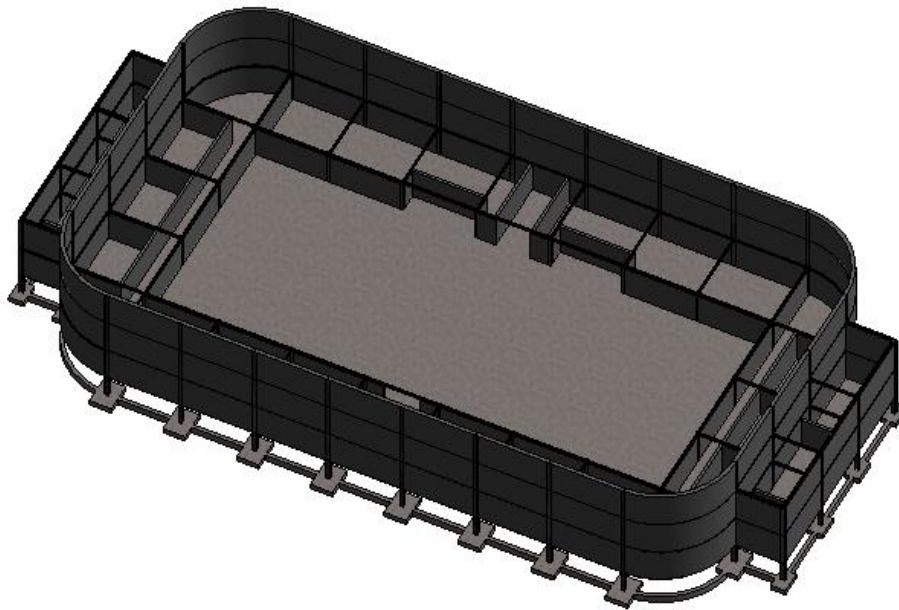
Vista 3D del modelado de los muros hasta el momento
